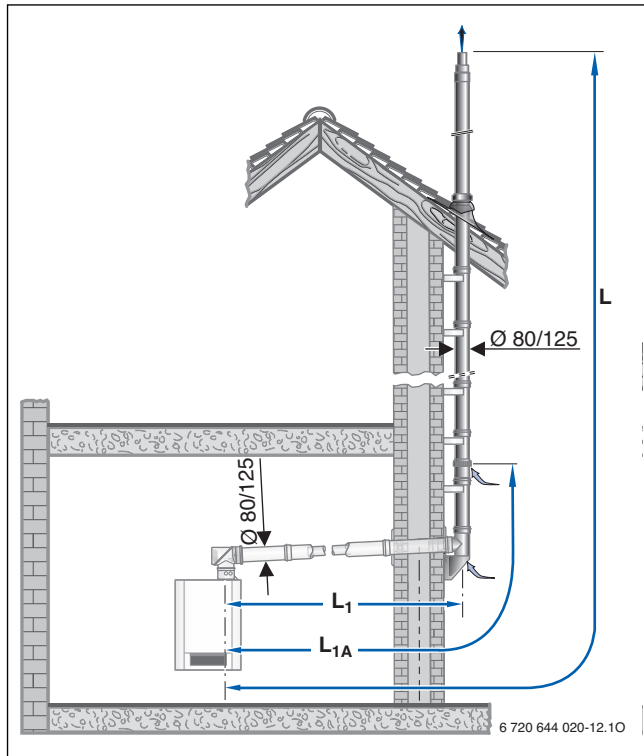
Montagevarianten mit dem Bausatz GAF-K
